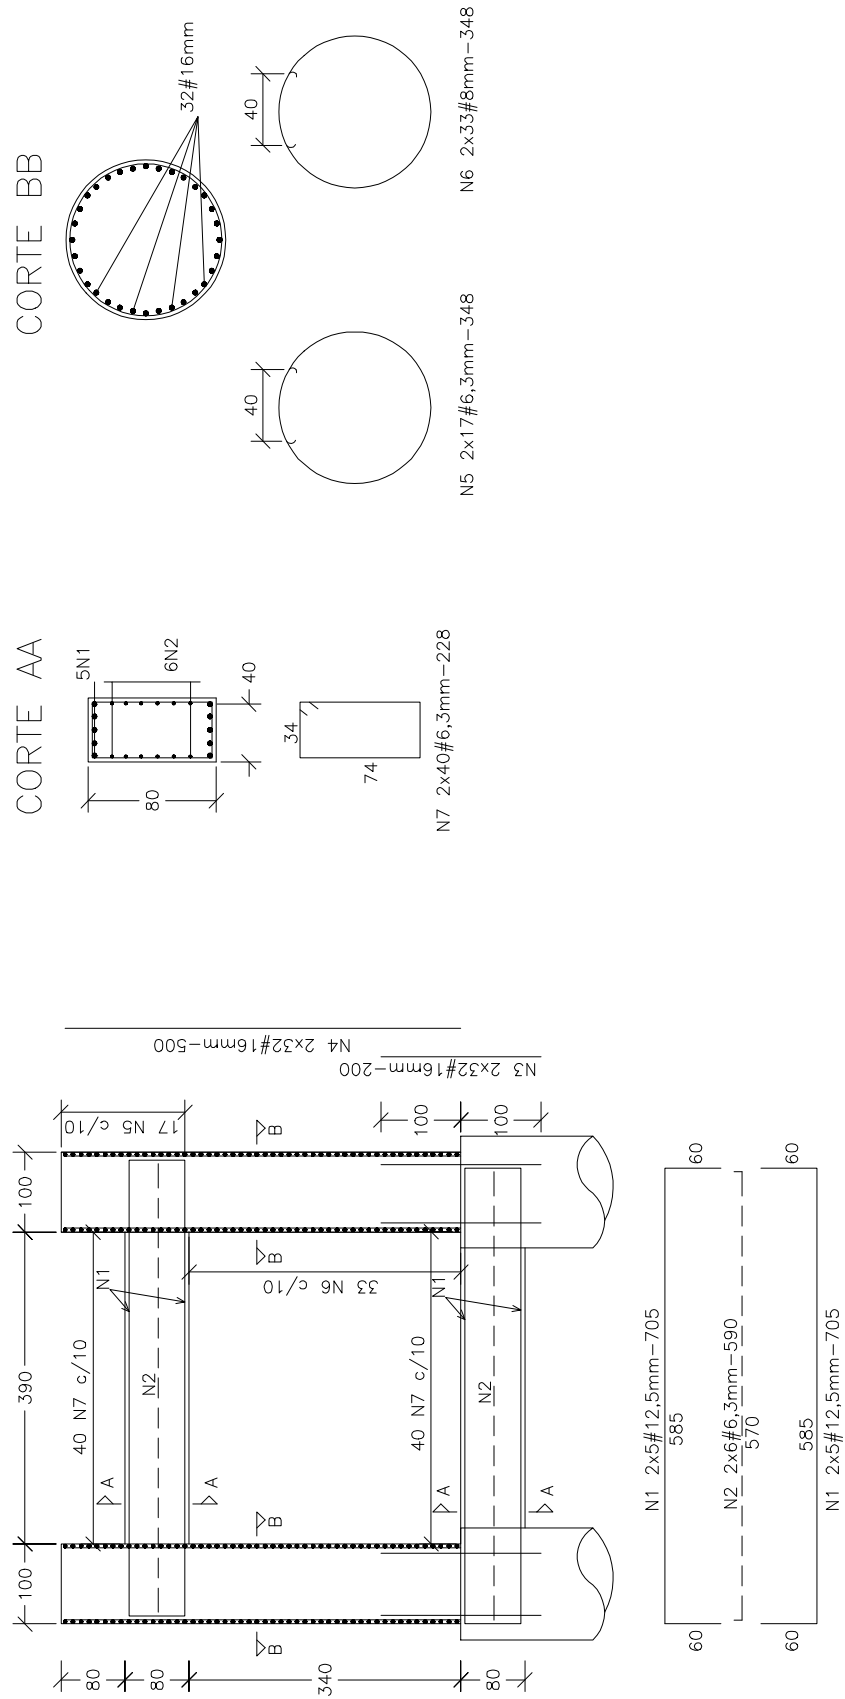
(a) - Detalhe da armadura do eixo 1 da ponte sobre o rio Pau seco.
